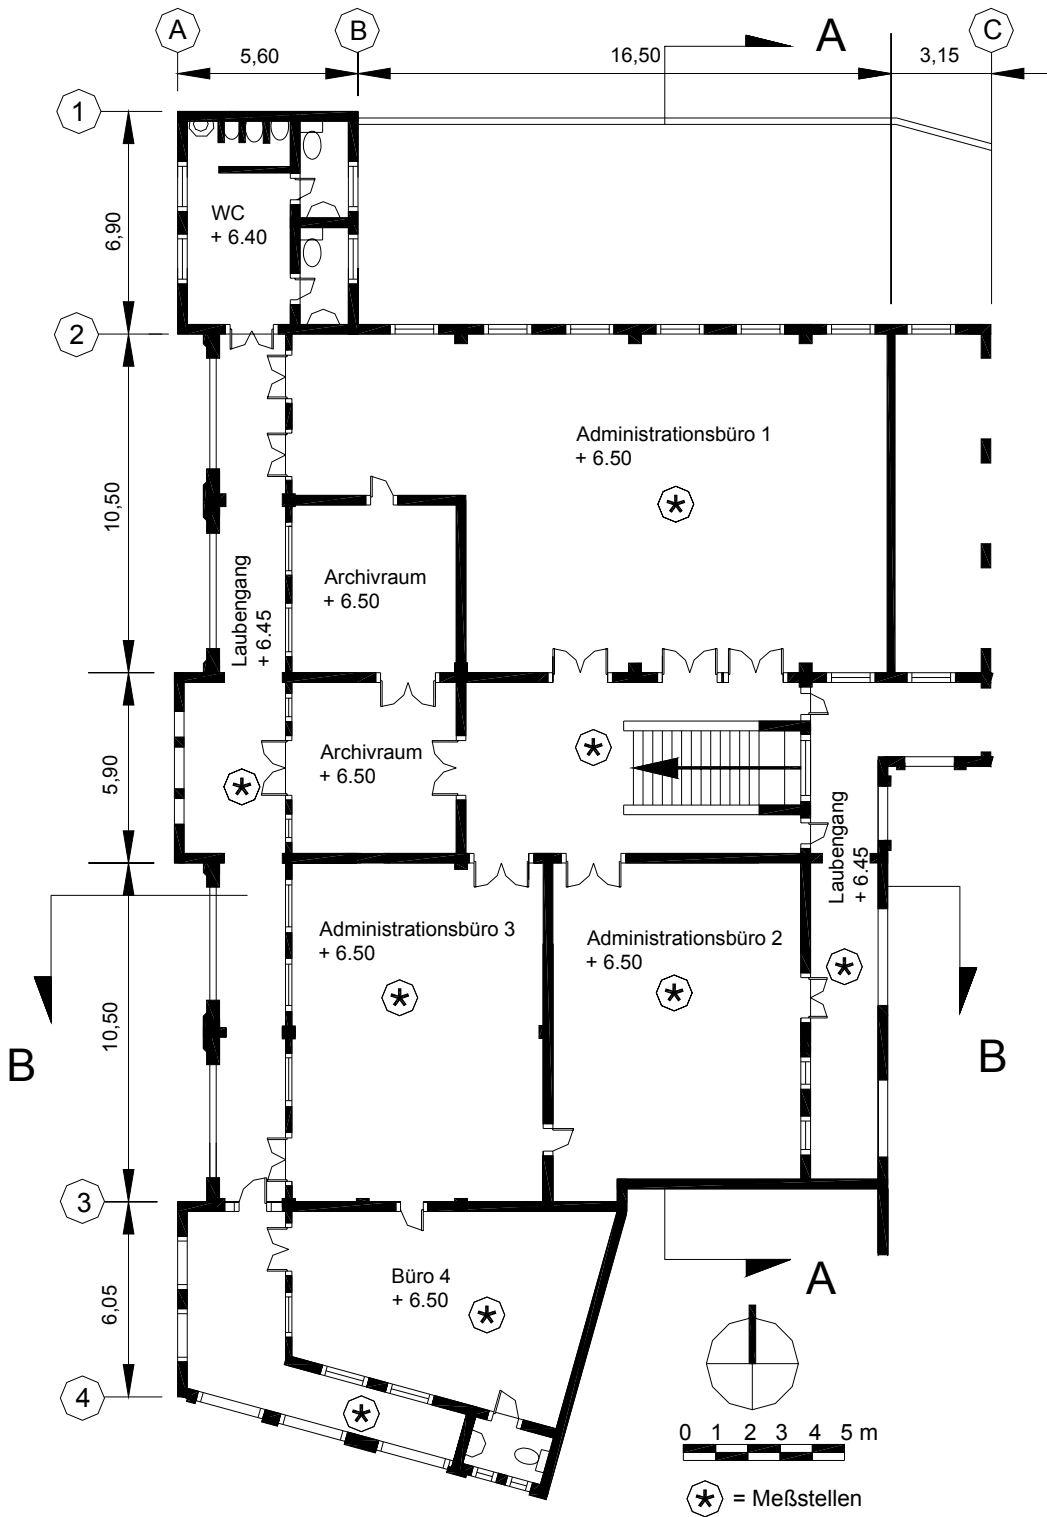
Grundriss 1. Obergeschoss von Gebäude C6
